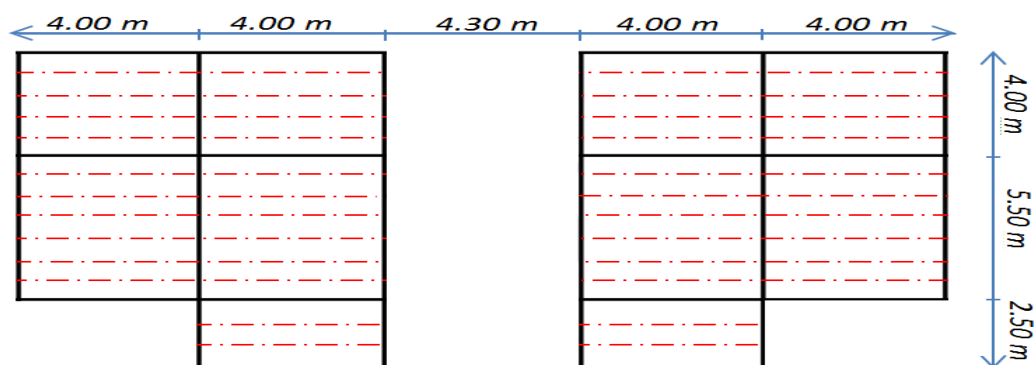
Types des poutrelles pour terrasse inaccessible.
